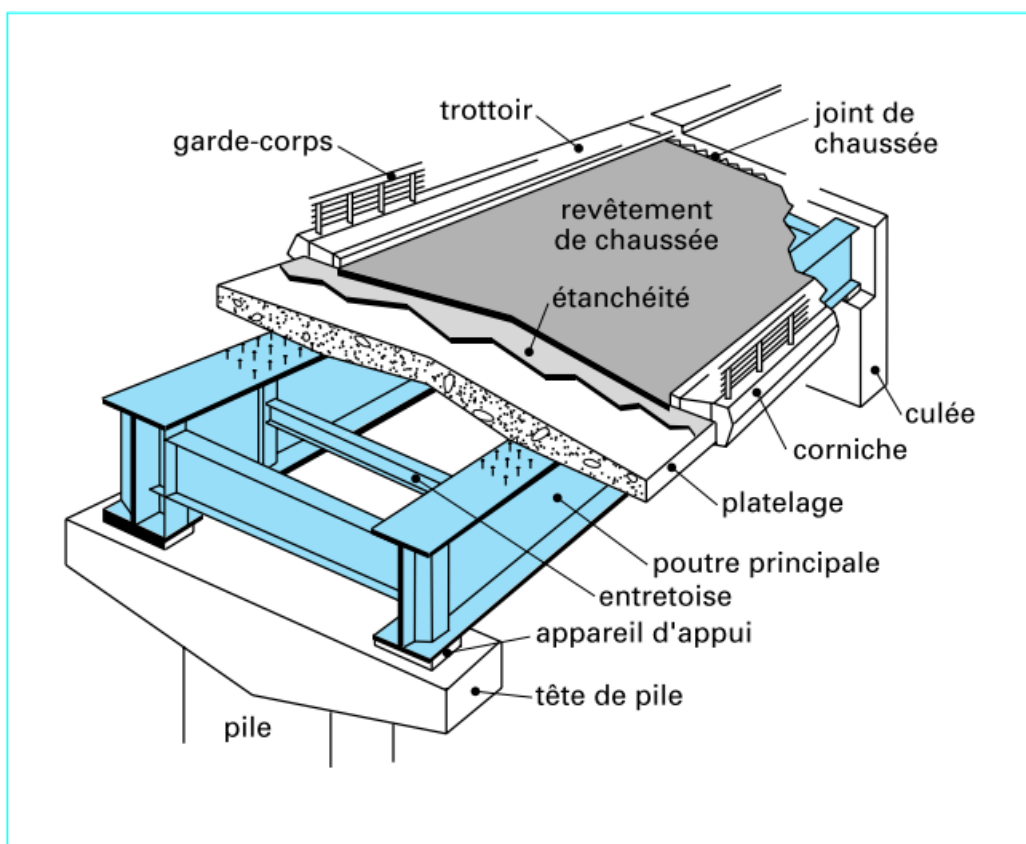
Les éléments d'un pont mixte bipoutre
